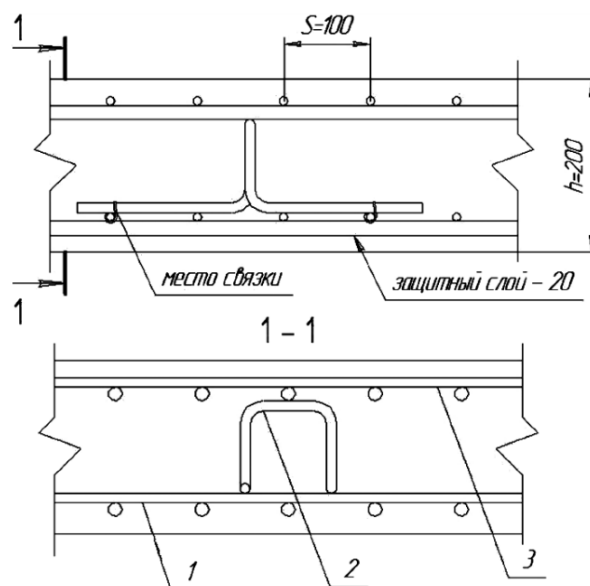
Подставка-фиксатор для установки в проектное положение верхних сеток перекрытия: 1 – сетка нижняя; 2 – фиксатор; 3 – сетка верхняя
